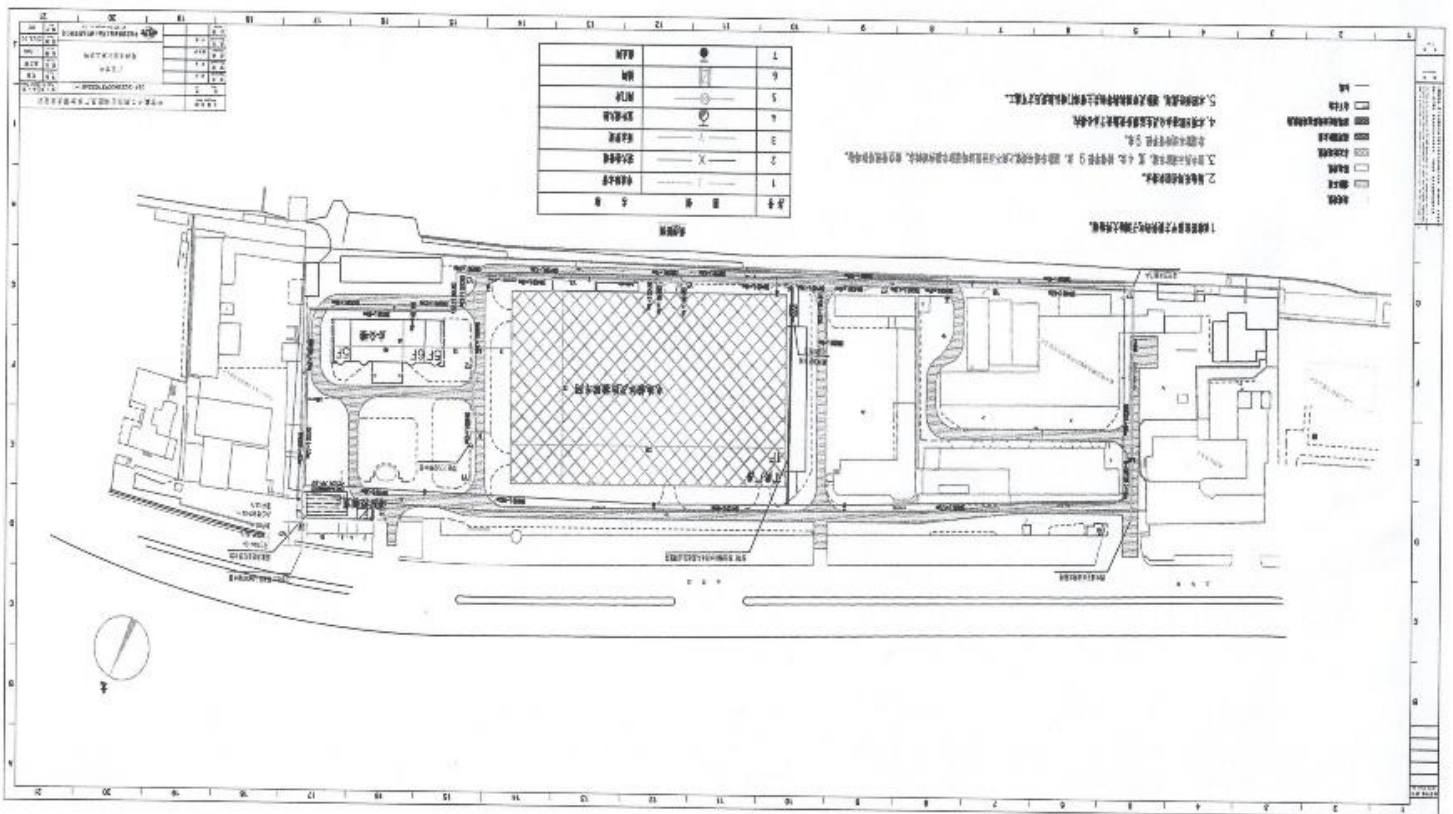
戴卡优艾希杰渤铝汽车零部件有限公司厂区平面图
